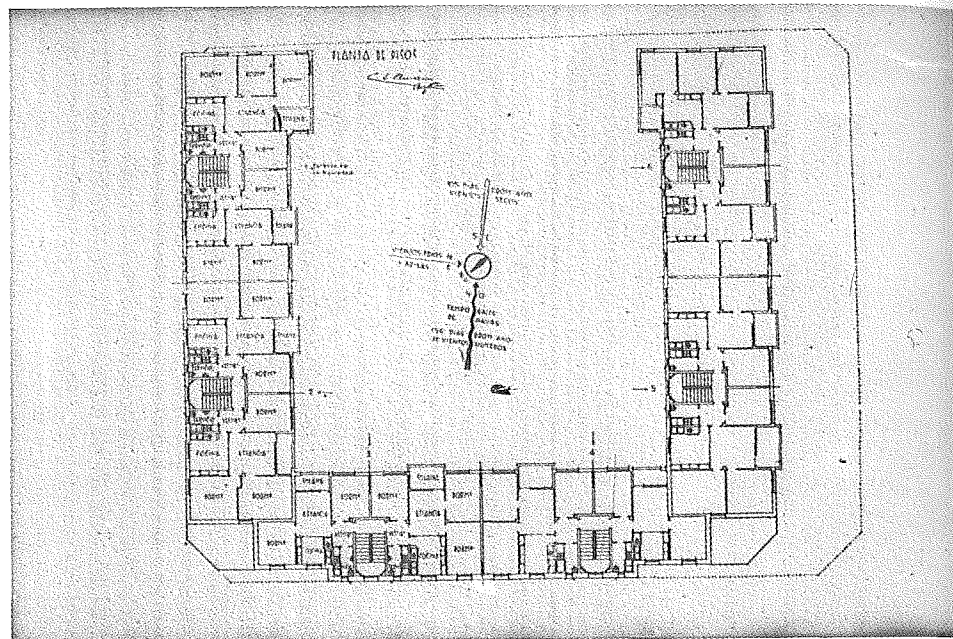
E. Amán: Planta de viviendas municipales en Solocoeche, Bilbao.
